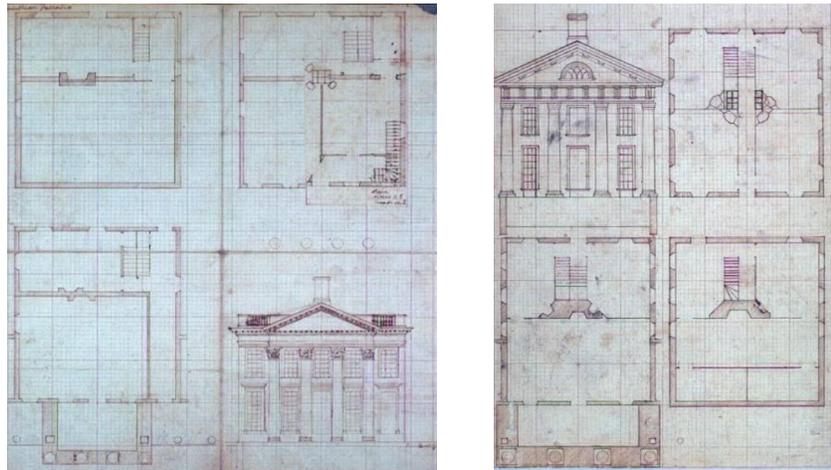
Pavilhão 3; Fig. 92 - Pavilhão 4
